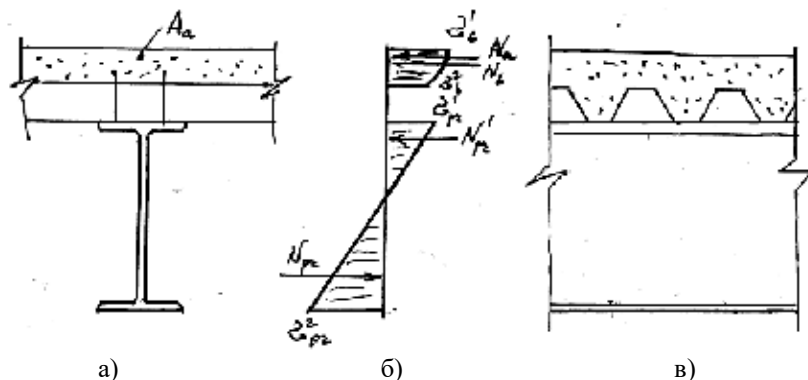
Расчетное сечение и схема усилий сталежелезобетонного сечения со стальным профнастилом: а) поперечное сечение; б) эпюра напряжений и схема внутренних усилий; в) фрагмент элемента вдоль балки (иллюстрация автора)
